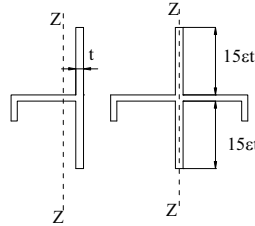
Irrigidimenti longitudinali dei pannelli d'anima
